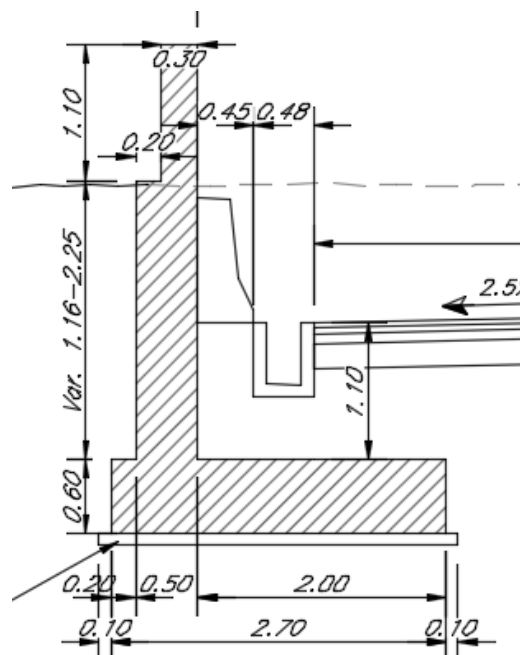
Sezione trasversale (muro di sostegno Tipo 1)
